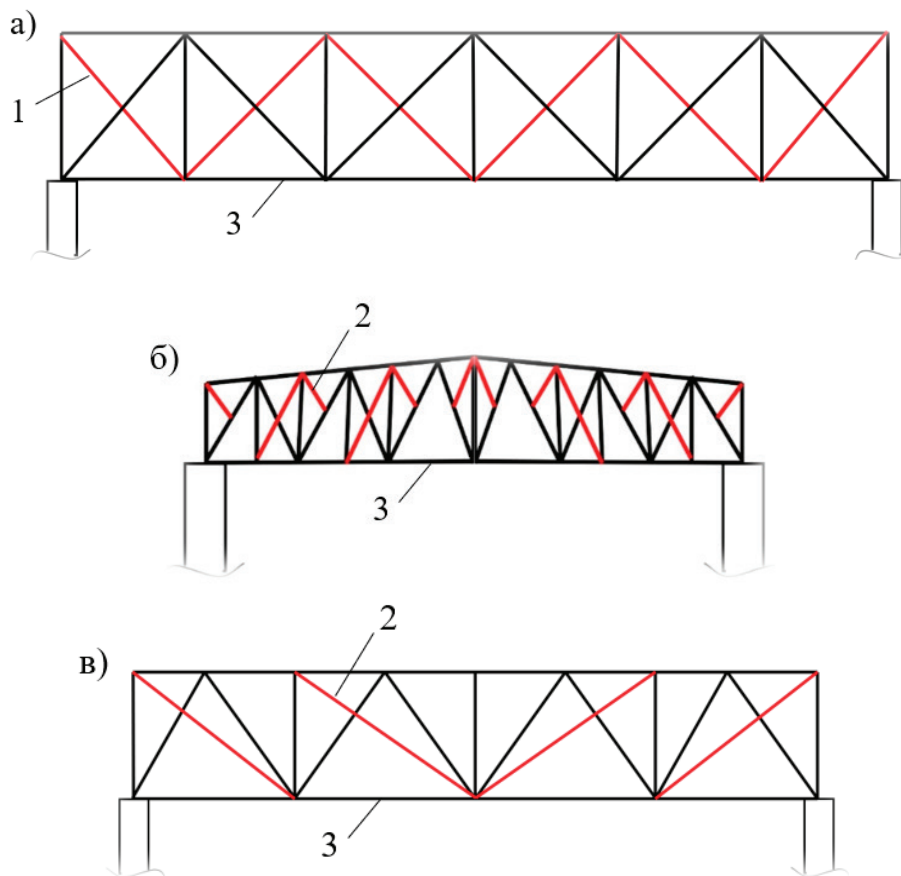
а) ферма с дополнительной решёткой; б, в) фермы с перекрёстной решёткой; 1 — вторая решётка, 2 — перекрёстная решётка, 3 — усиливаемая ферма
